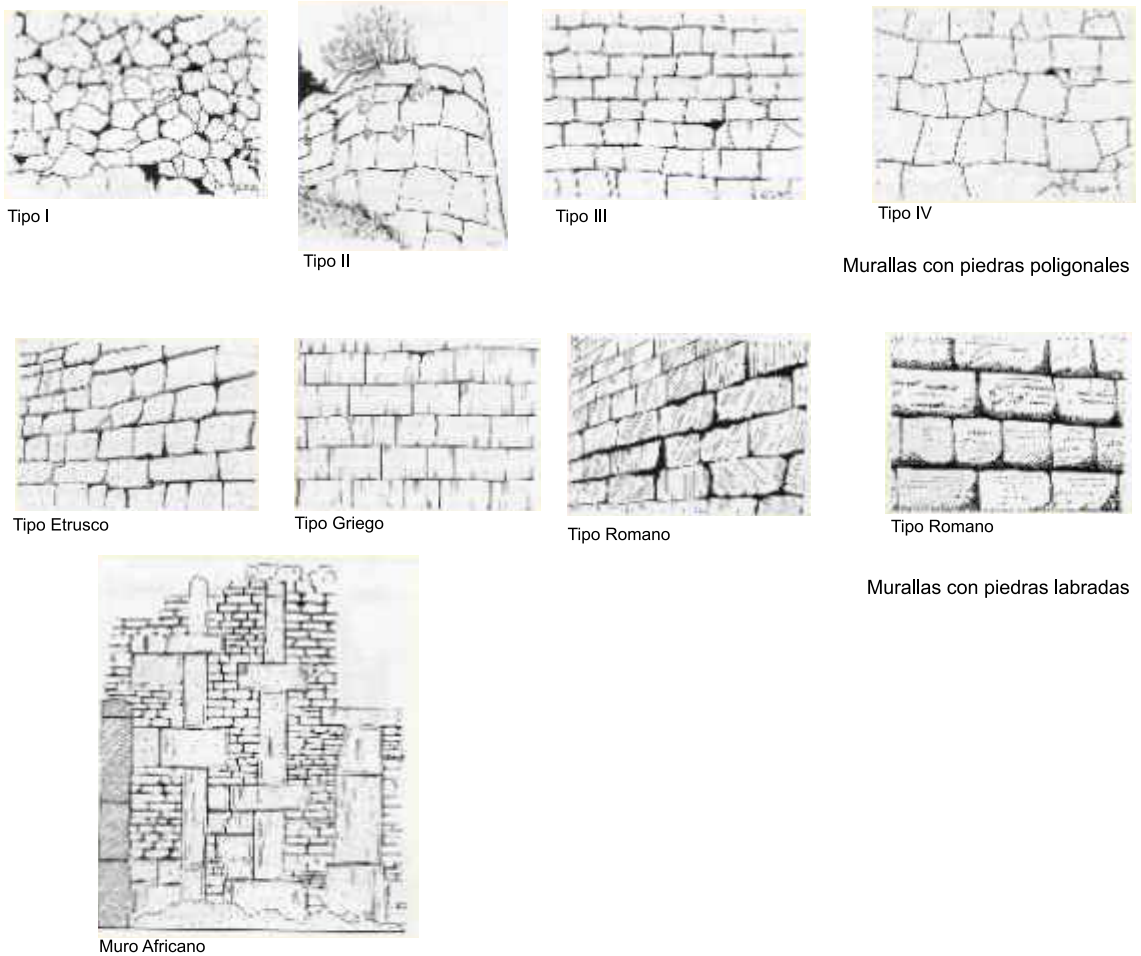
Mampostería para murallas (Marinucci, 1988)
